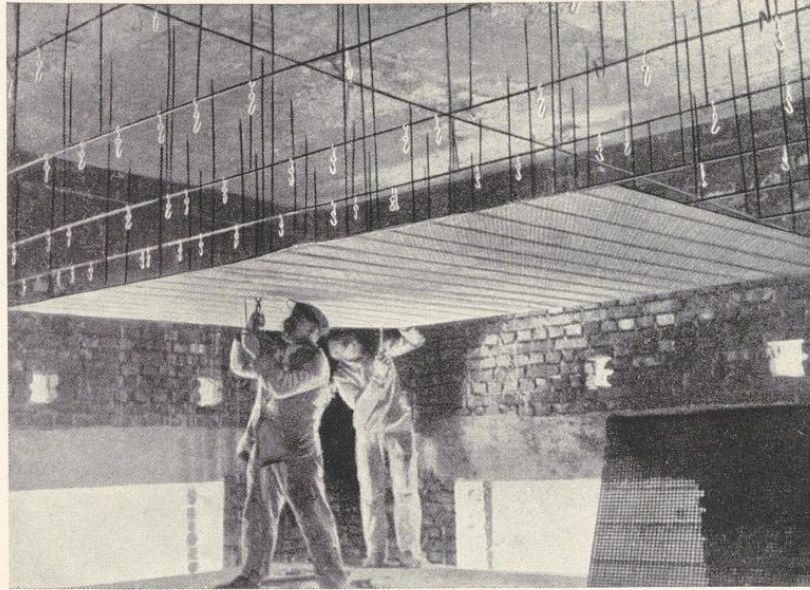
Rabitzdeckenkonstruktion mit aufgehängten Stauziegel-Gewebematten
